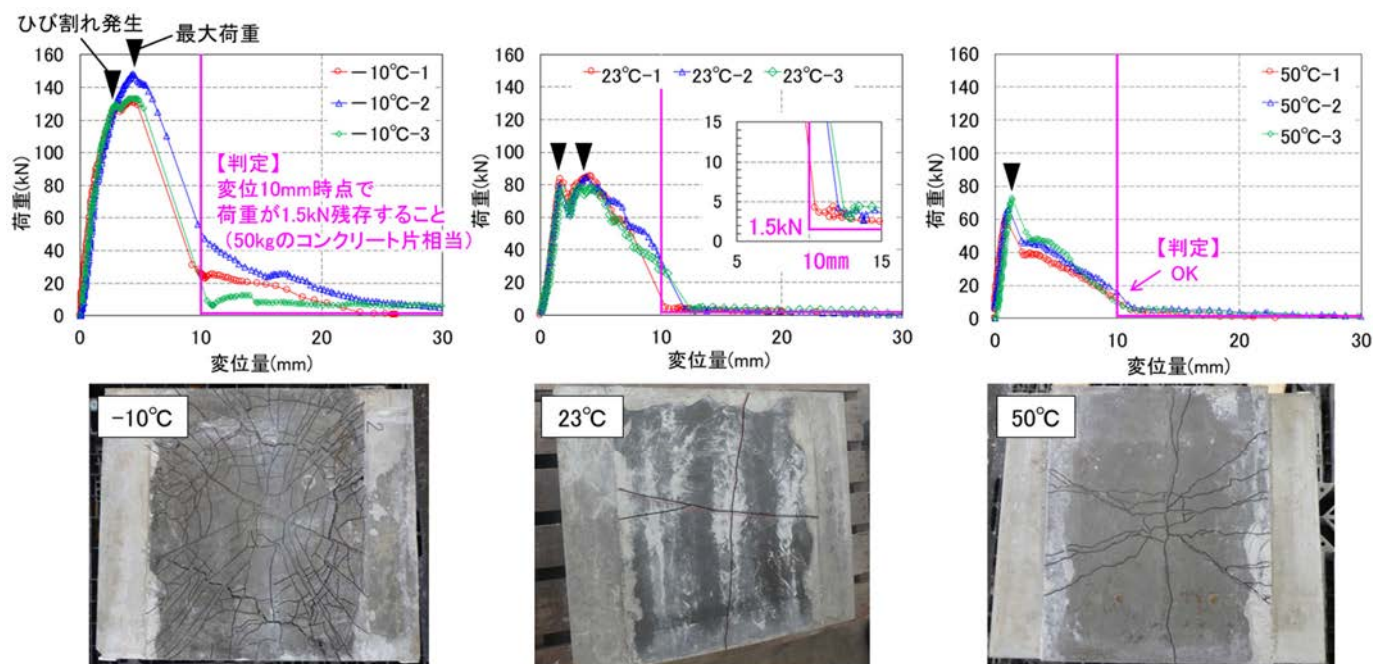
荷重-変位曲線およびひび割れ状況（埋設型枠の押抜き試験）
